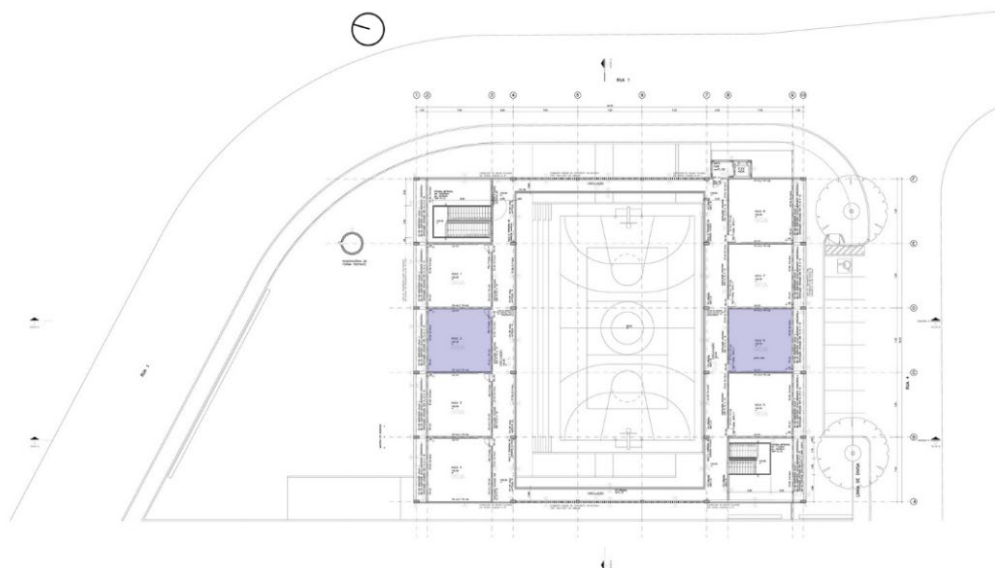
Imagem Planta segundo pavimento FDE Campinas com as salas de aulas do estudo. Fonte: Divulgação MMBB, 2003
